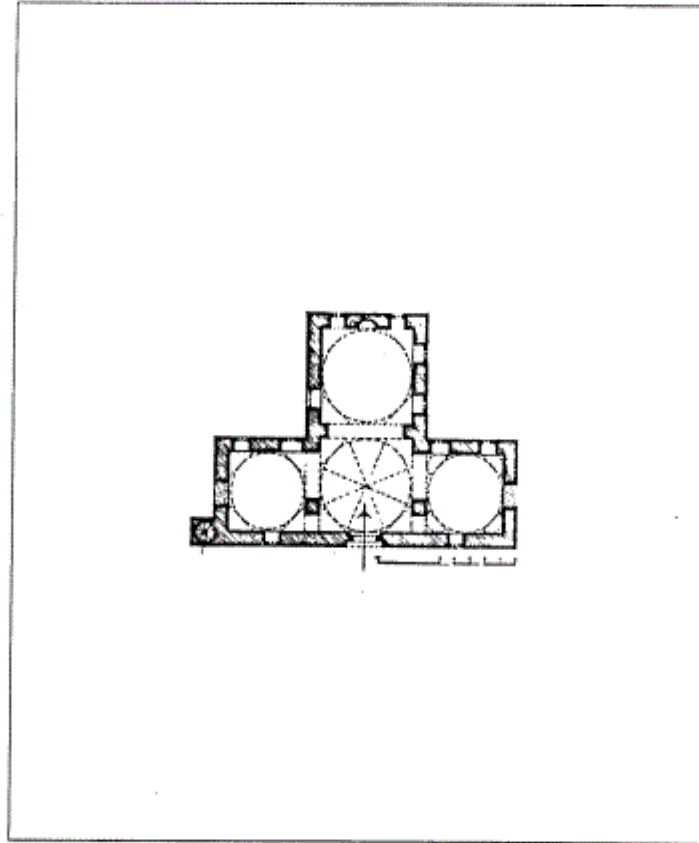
مسقط أفقي لمسجد غازي ميخال في أدرنة (عن: اصلان ابا)
